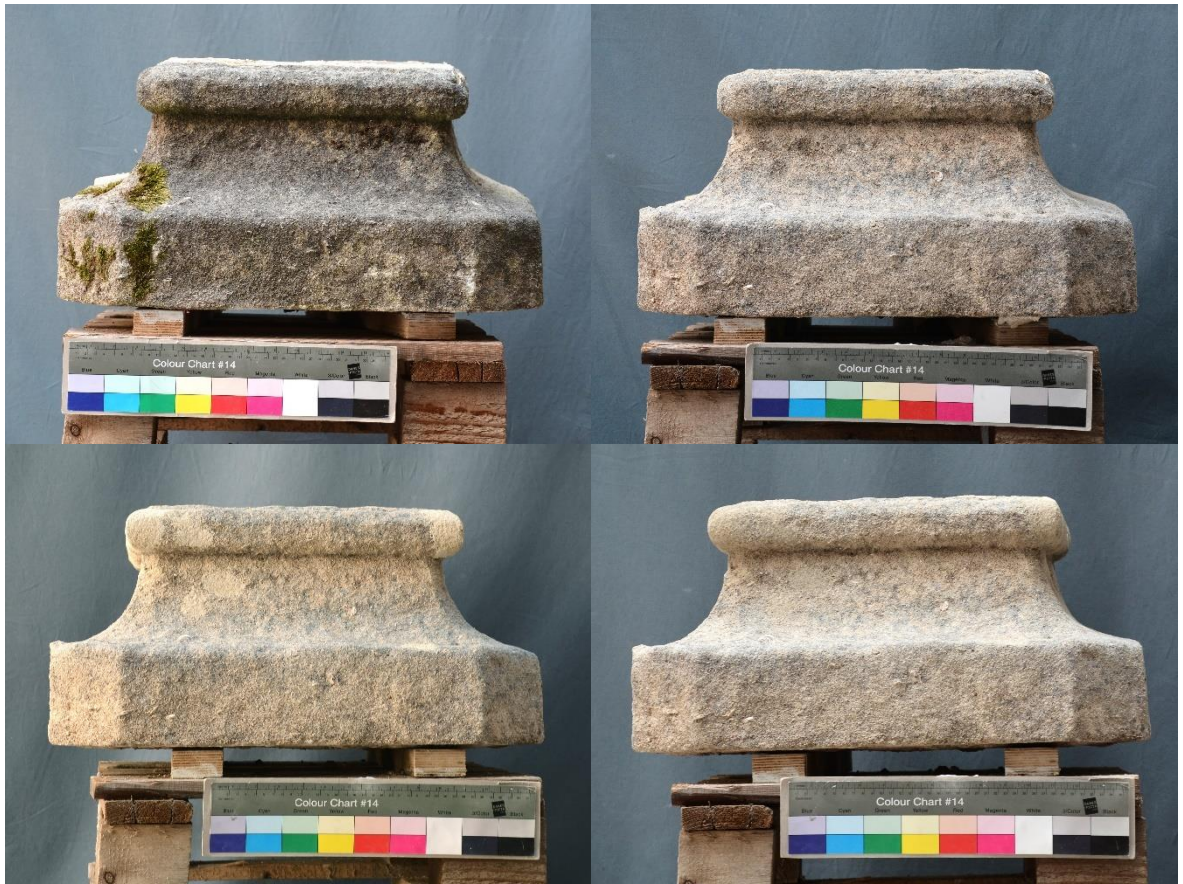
Fotografie soklu po restaurování – zadní strana
